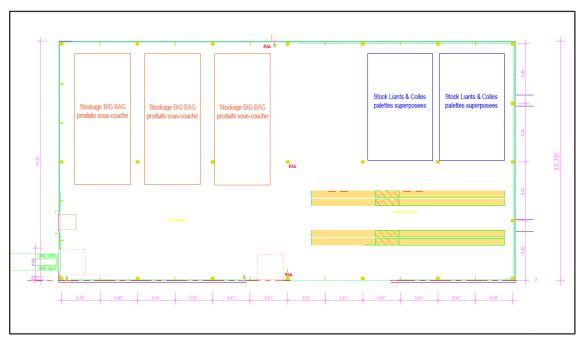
Stockage futur bâtiments (source : sicabconstruction)
